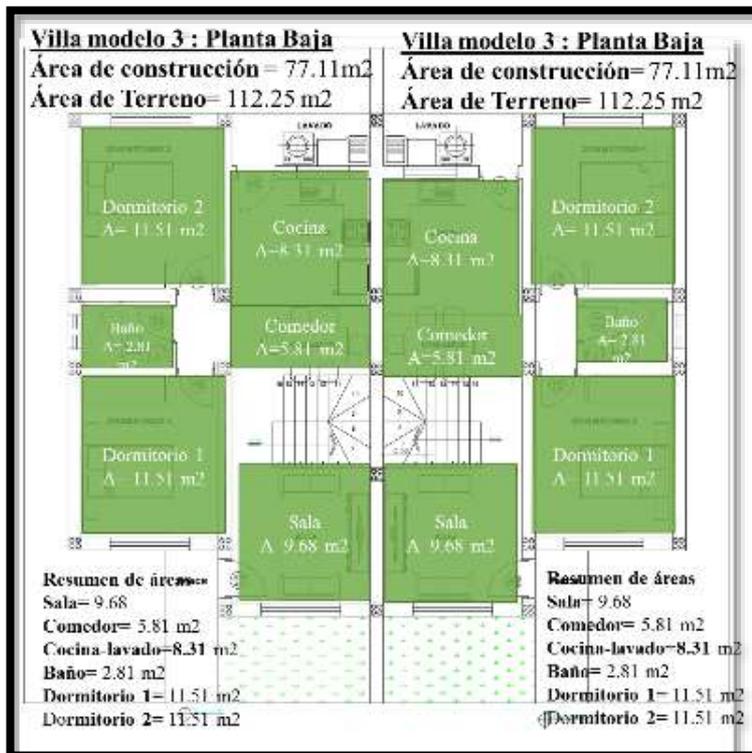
Cuadro de área – Planta Baja Modelo 3
